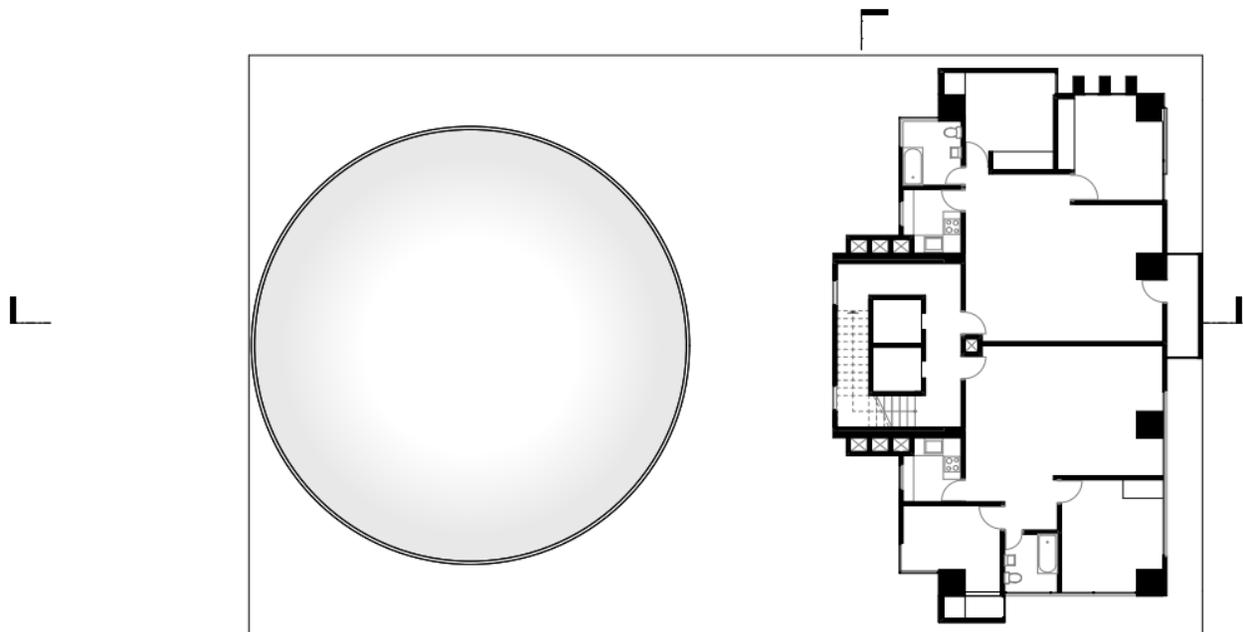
Planta alta original N+24.50. Fuente: Tesistas.
